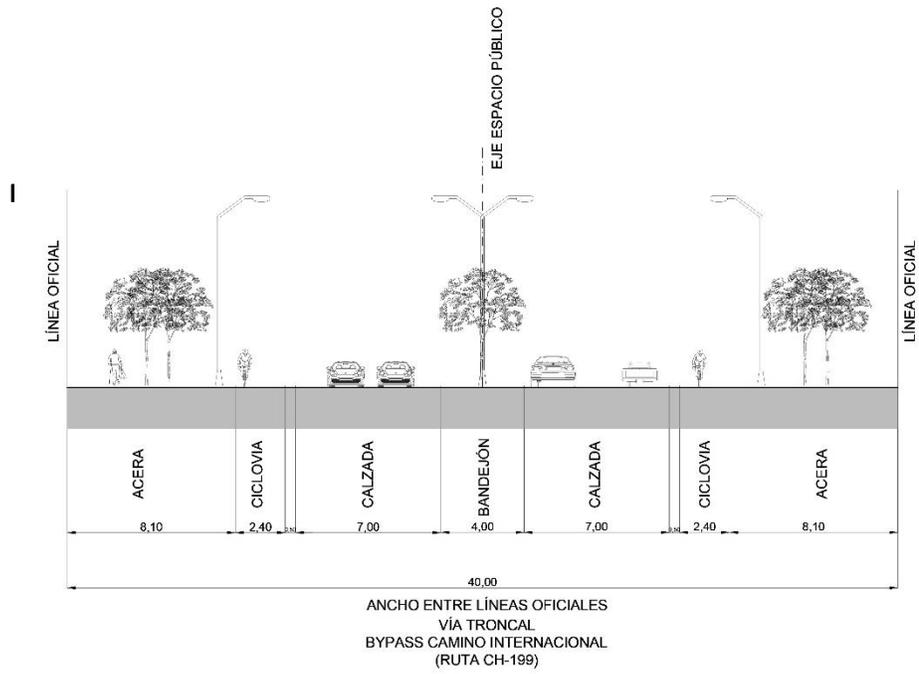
Perfil Vial Vialidad Troncal. Fuente: Elaboración propia
